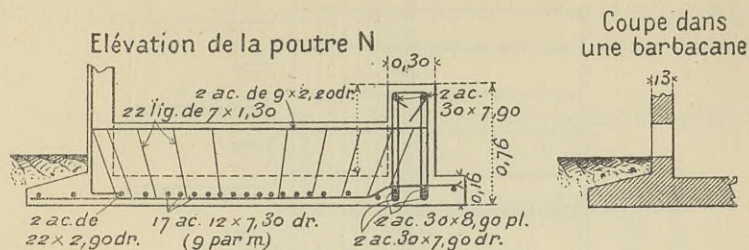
Mur de soutènement à Longwy, armature de la semelle d'appui.
